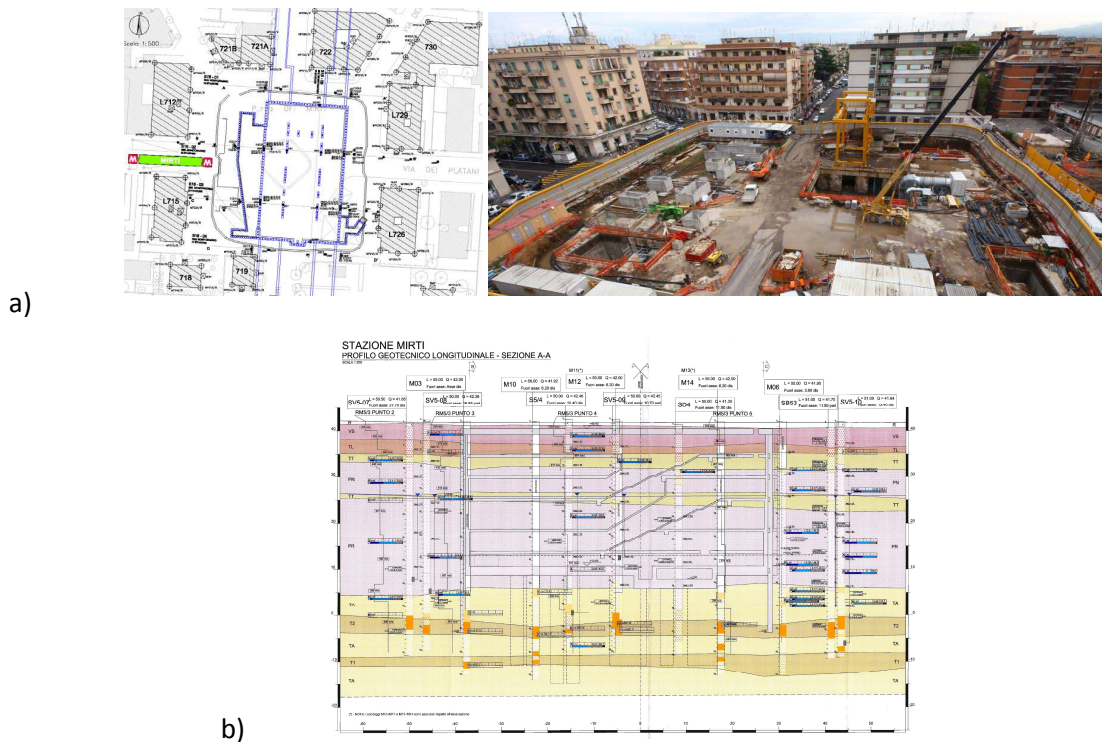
Stazione Mirti: a) Planimetria e veduta di insieme b) Sezione geotecnica longitudinale
